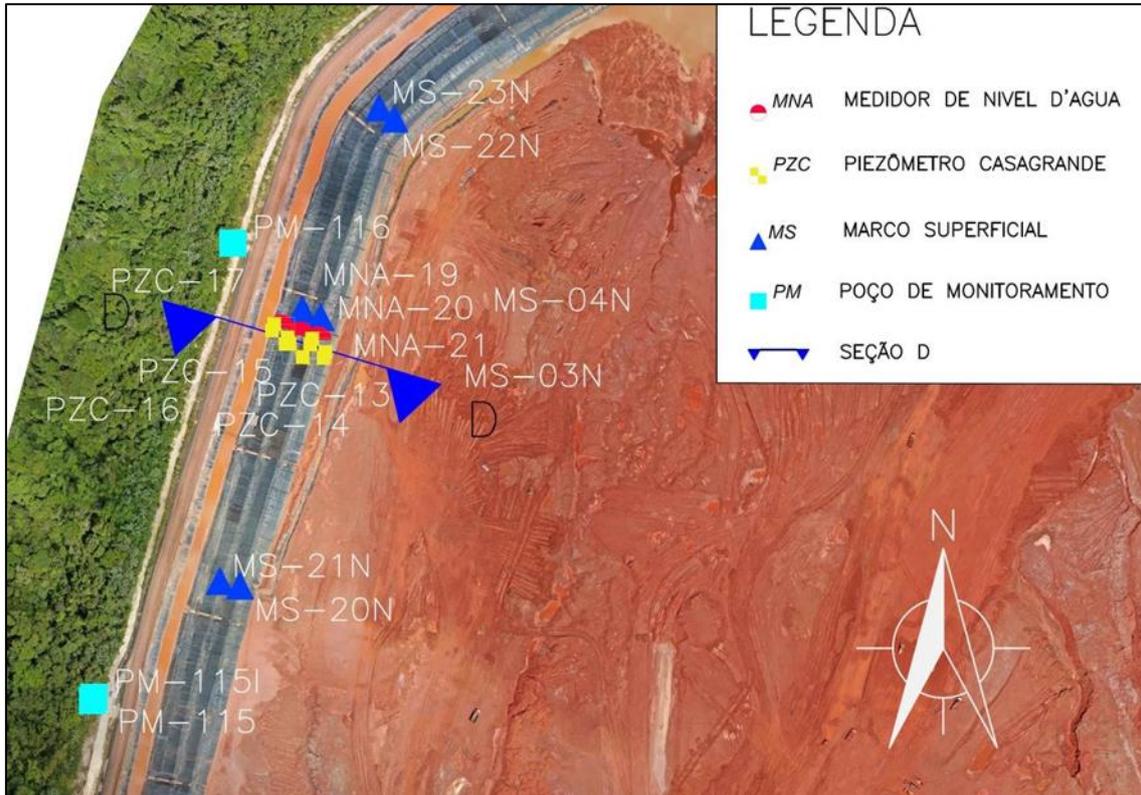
Localização em planta da instrumentação instalada na Seção D (PIMENTA DE AVILA, 2022)
